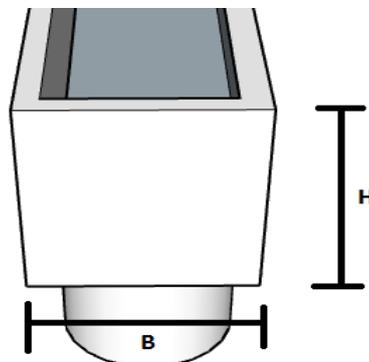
Geometria do conduto horizontal (calha) utilizado para dimensionamento pluvial.
